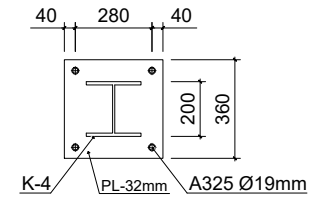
DETAIL SAMBUNGAN K-1 & PEDESTAL
